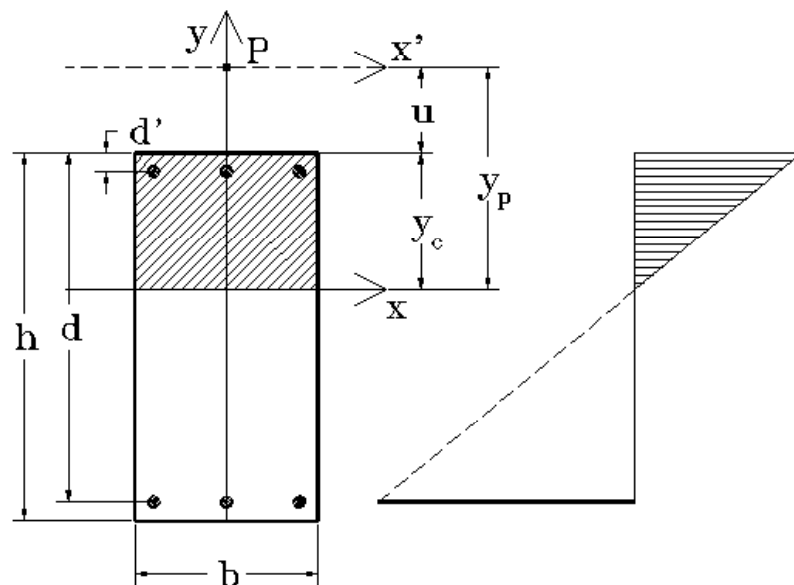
Sezione rettangolare soggetta a pressoflessione retta
